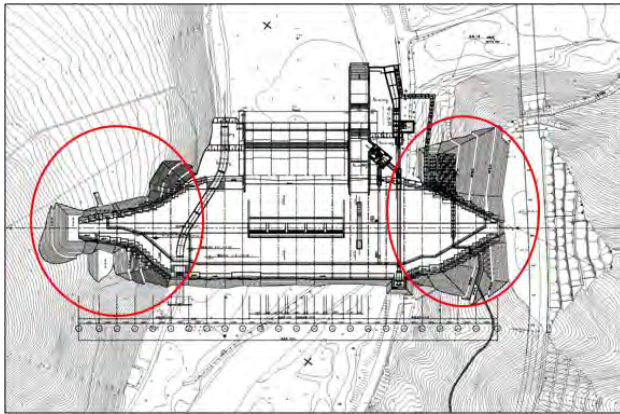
平成 25 年度基礎掘削工事箇所 (平面図)
